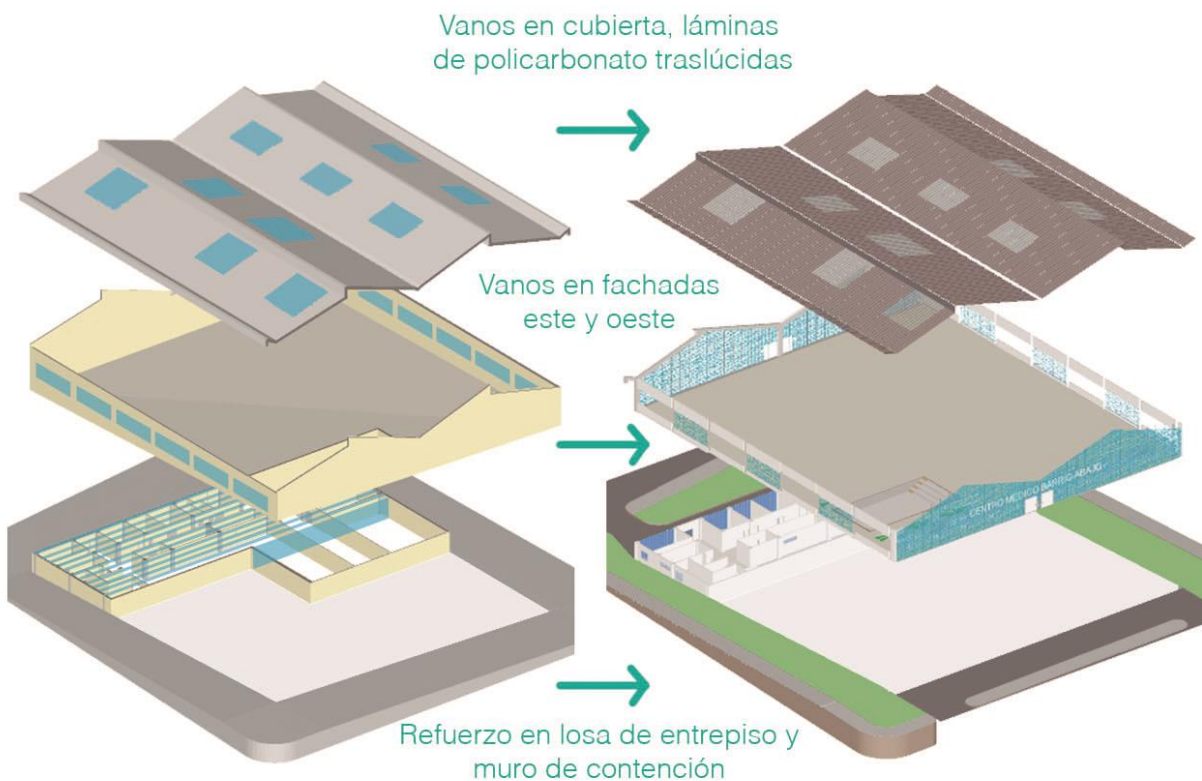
Esquema de renovación y refuerzo en relación a la situación actual y la propuesta de intervención.
